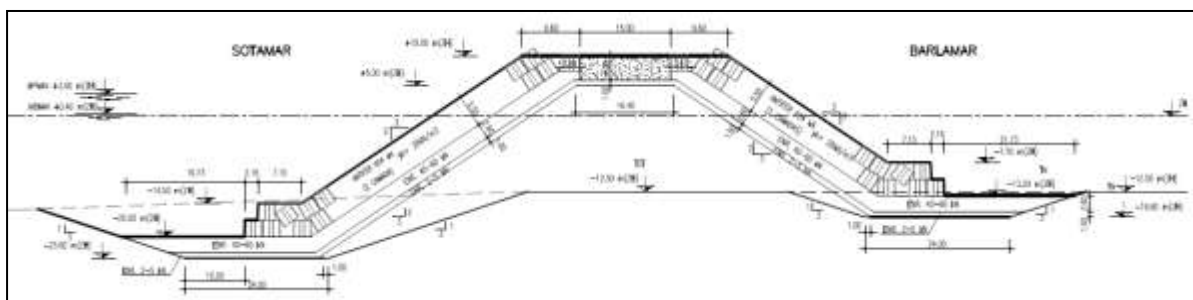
Perfil transversal tipo da cabeça do quebramar
